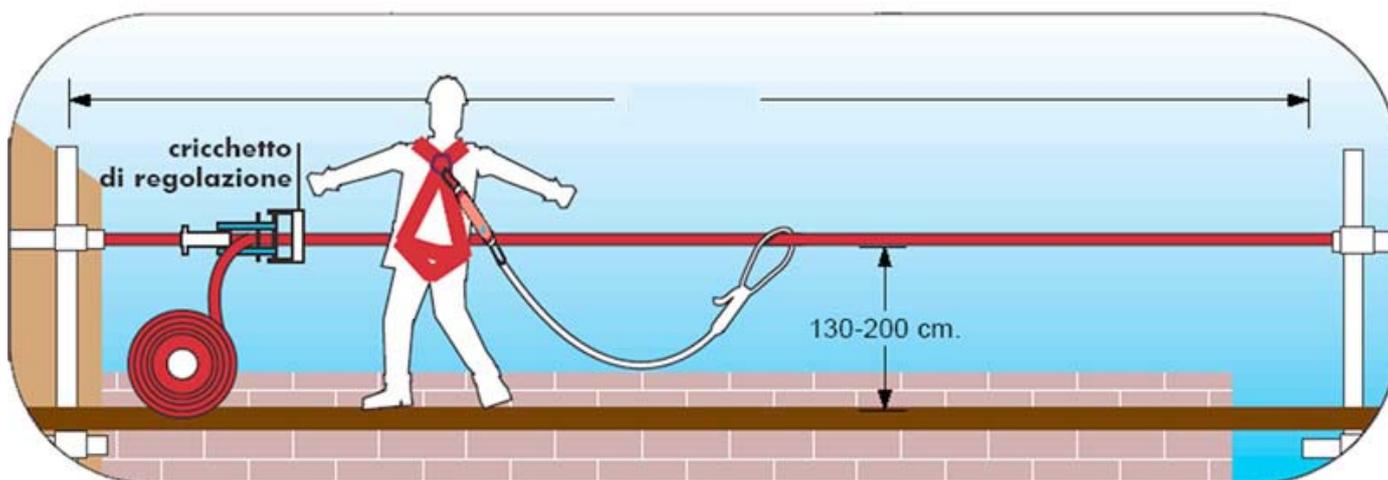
Utilizzazione con ancoraggio ad elementi strutturali
